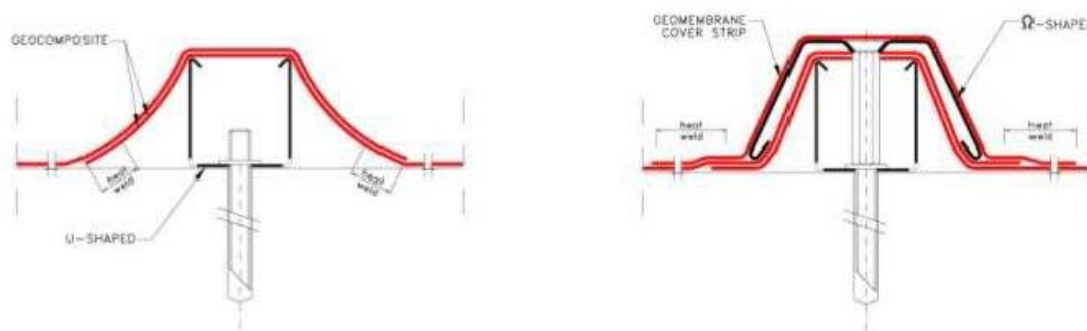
juntas de contracción en donde se presentaron grietas, aplicando un geocompuesto impermeabilizante.
